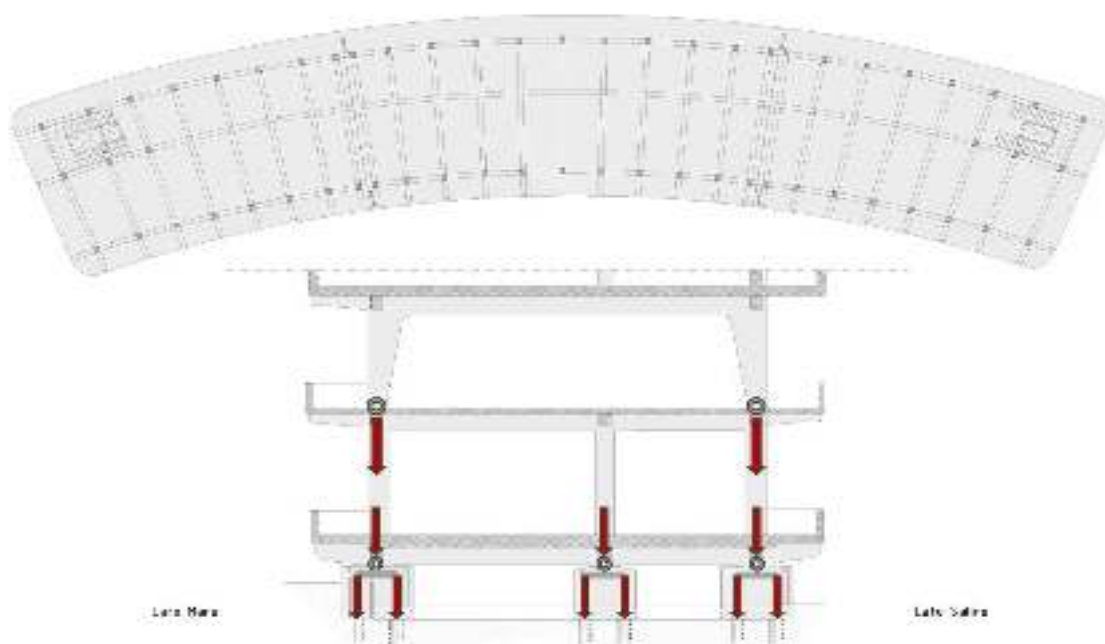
Colonia marina Dux. Pianta e sezione dei telai con lo schema del sistema di forze
